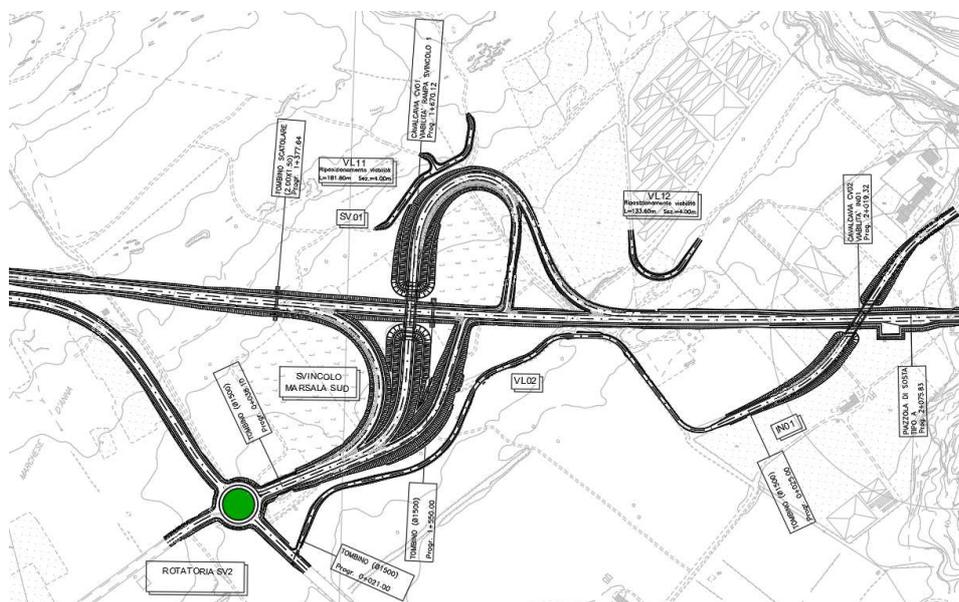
Planimetria dello svincolo di Marsala Sud e rotatoria 2
